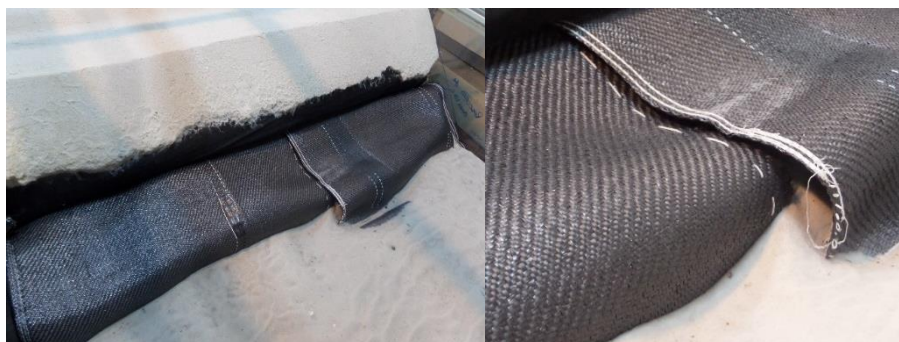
Pormenor da erosão localizada na sobreposição das telas no final do ensaio.
